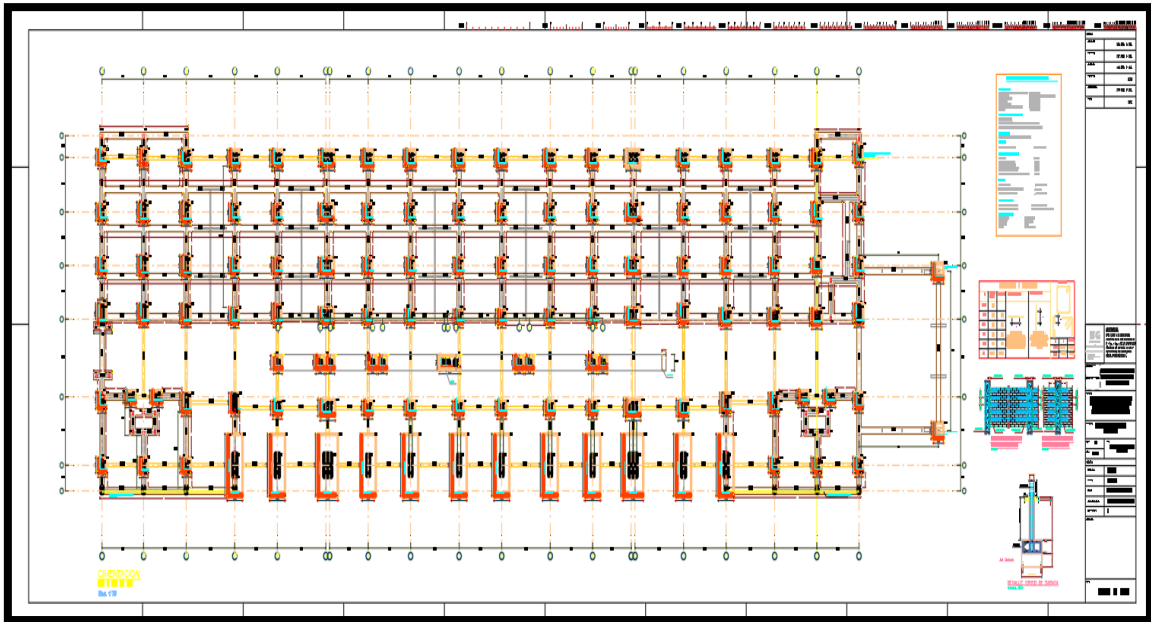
Plano de estructura de cimentación para edificación del terminal terrestre
